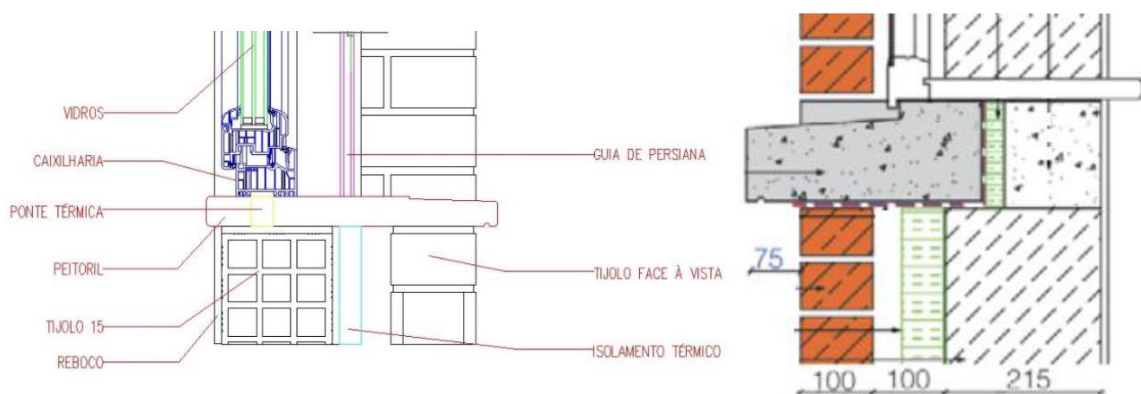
Cortes de zona de vão com peitoril bem dimensionado [62]
